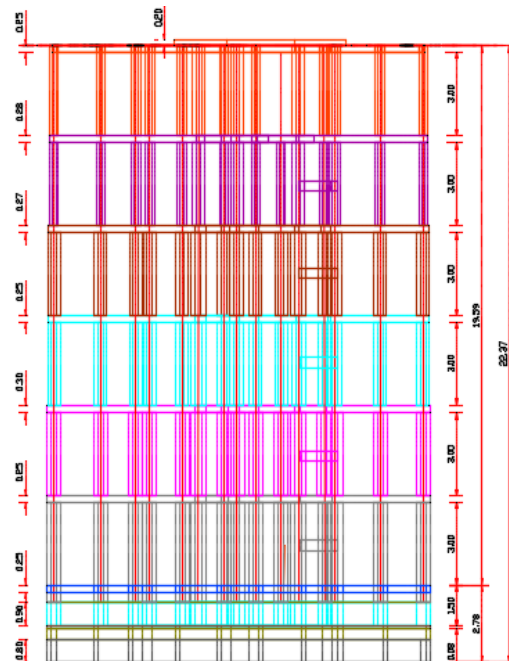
Vista en planta con medidas del edificio Yam Yam.
